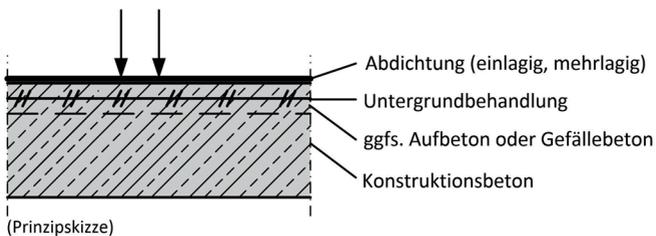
Nicht belüftetes befahrbares Dach (Parkdach Pkw)
